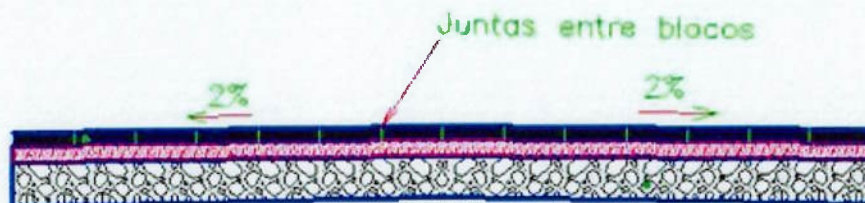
Seção do pavimento intertravado (Secretaria de Habitação de Osasco)
